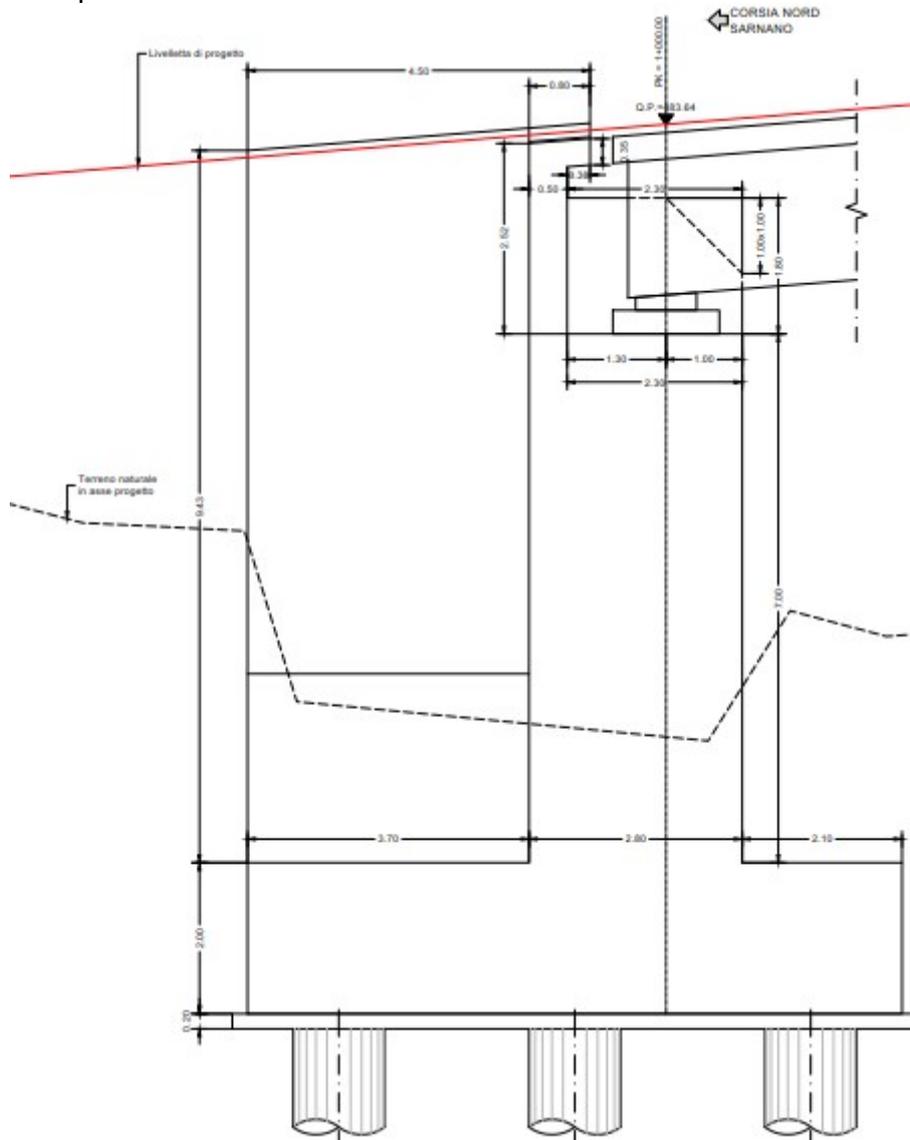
Sezione trasversale spalla A lato Sarnano
